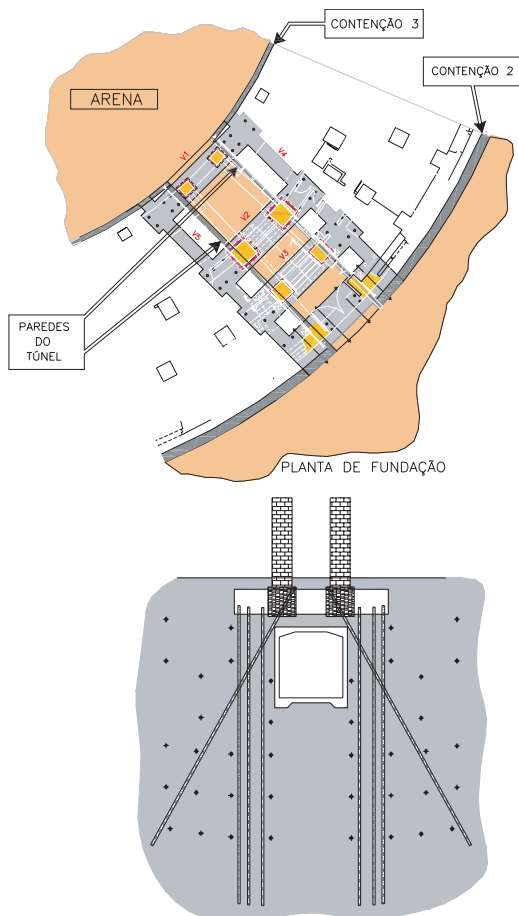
Planta e corte do sistema estrutural concebido para a execução dos túneis
